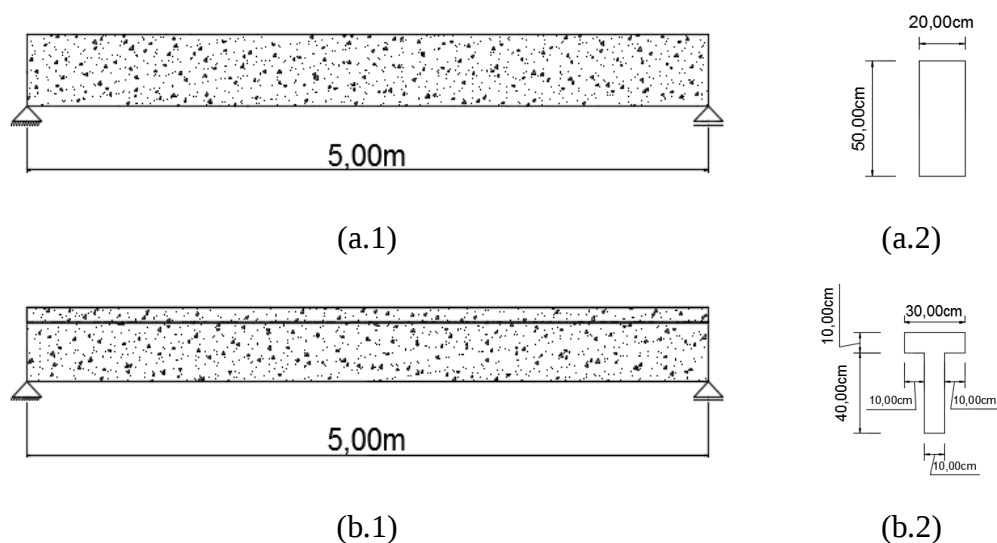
Vigas analisadas – (a) VR; (b) VT
